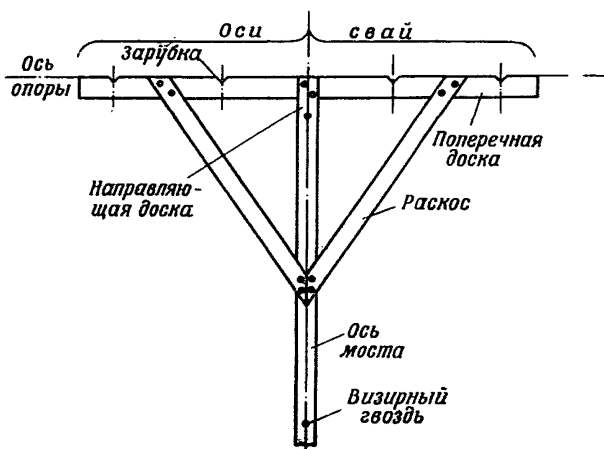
Т-образный шаблон для разбивки осей свай в опоре
